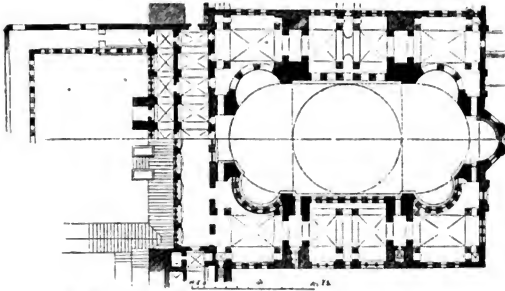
Grundriss der Sophienkirche in Constantinopel (nach Rahn).
